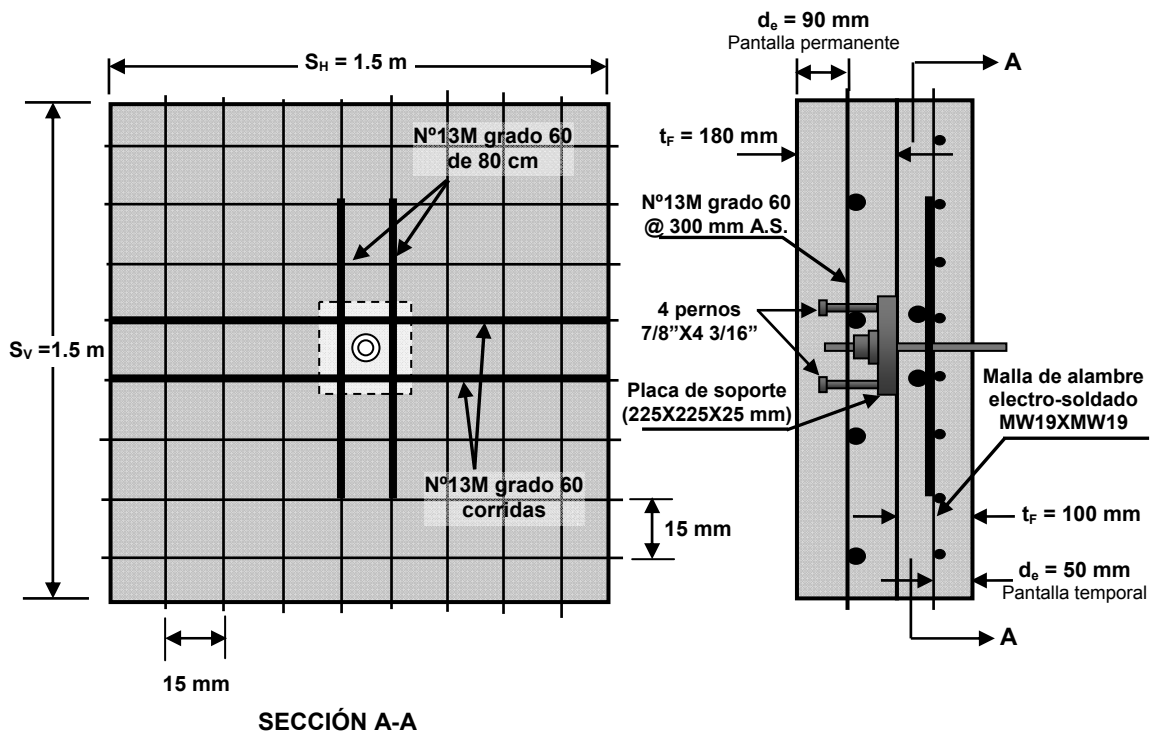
Detalle del refuerzo para una pantalla doble de revestimiento del muro
